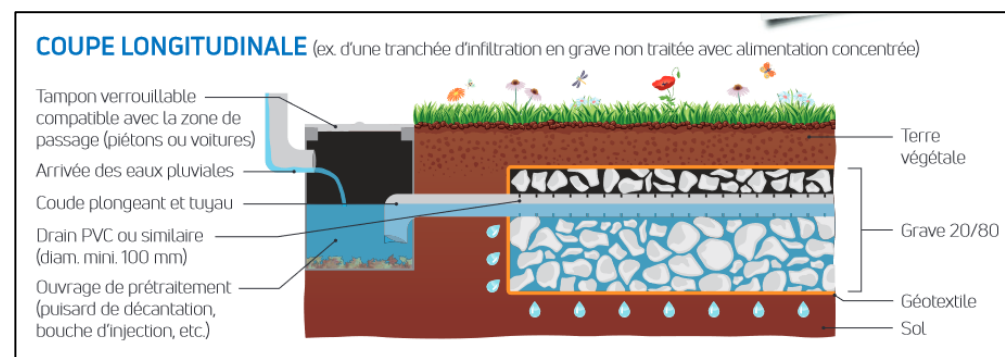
Tranchée d'infiltration (Source : ADOPTA)
